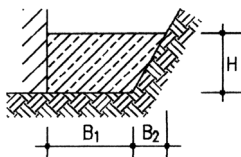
Füllbeton zwischen Bauwerk und Erdreich
